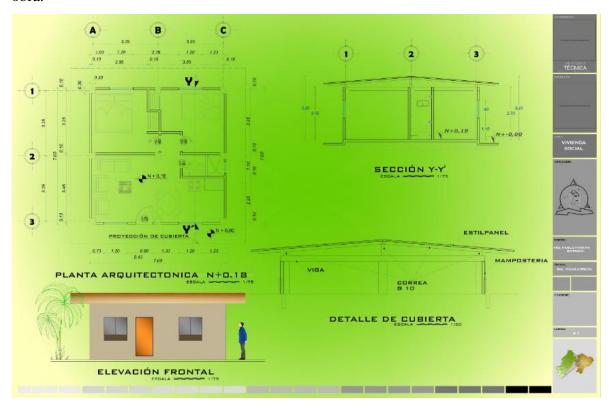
Propuesta de proyecto para la fabricación de viviendas destinada a los damnificados del terremoto del 16 A, utilizando acero galvanizado en su construcción
